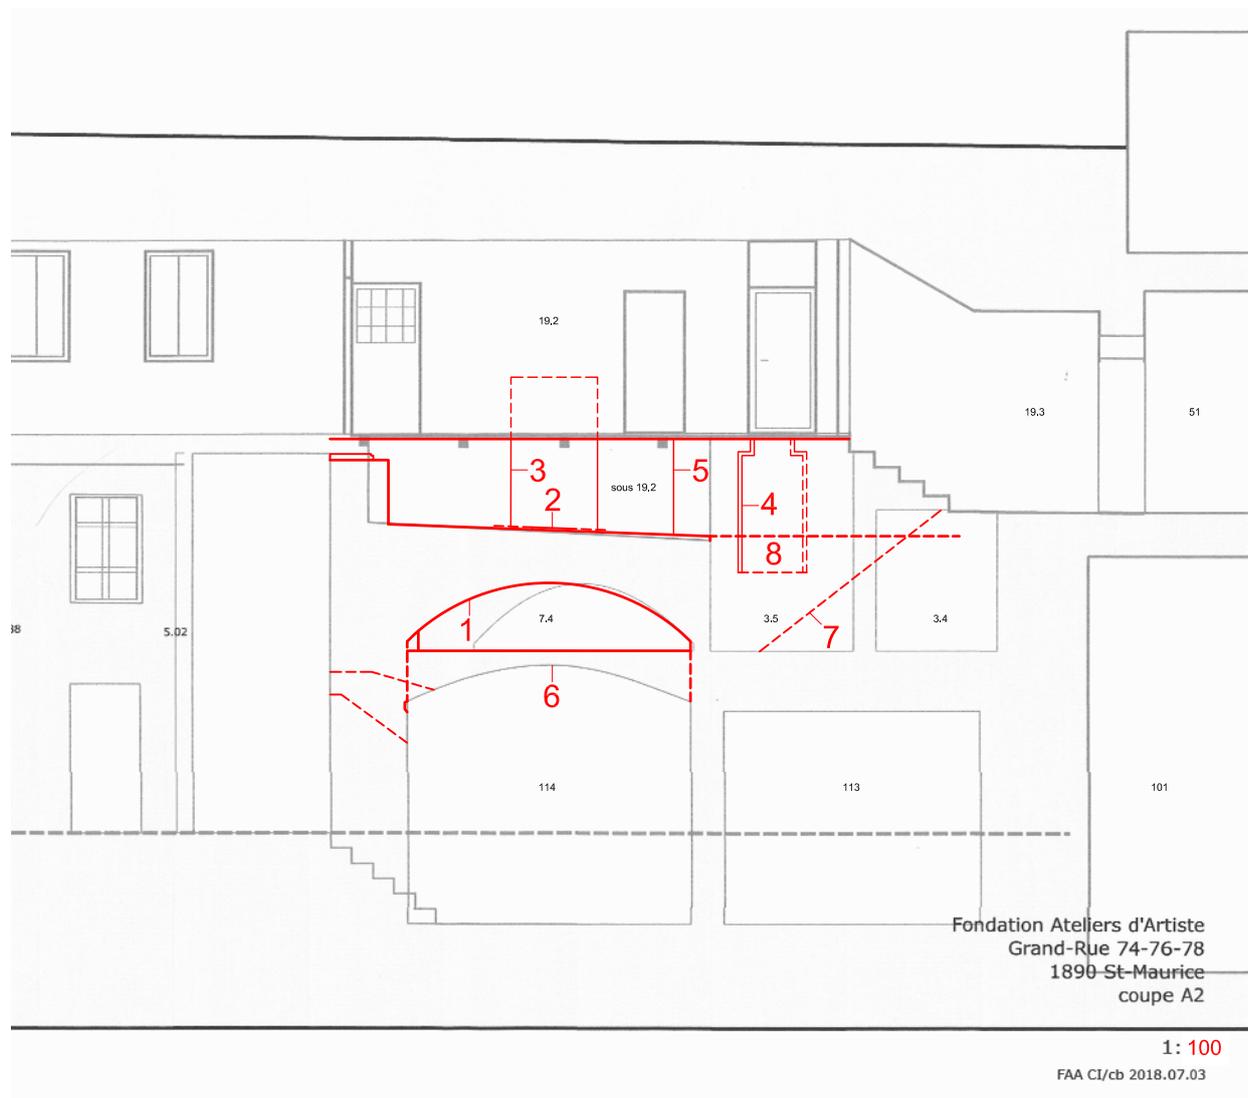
Coupe nord-sud, vue ouest, du bâtiment à la hauteur des locaux L7.4 et L3.4. En rouge, les éléments archéologiques observés sur place. Sur la base du levé effectué par la Fondation Ateliers d'Artiste.
